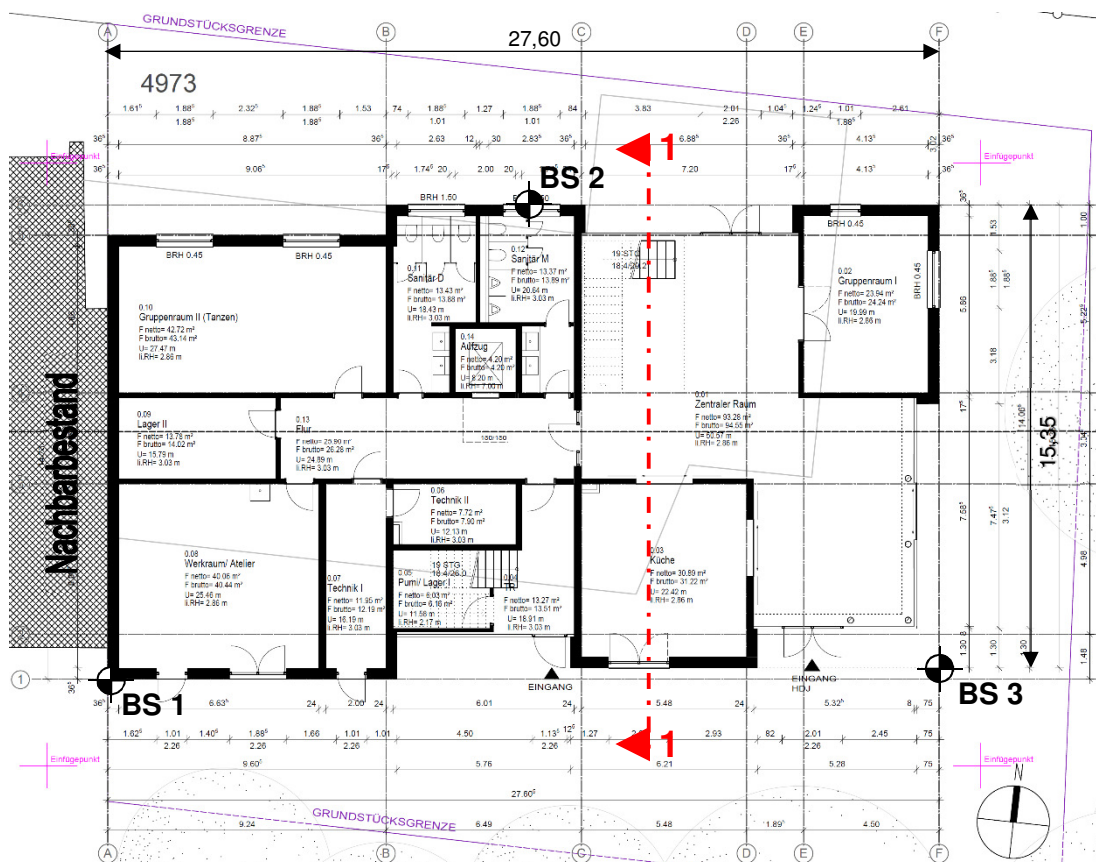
Grundriss Erdgeschoss, M 1:250
